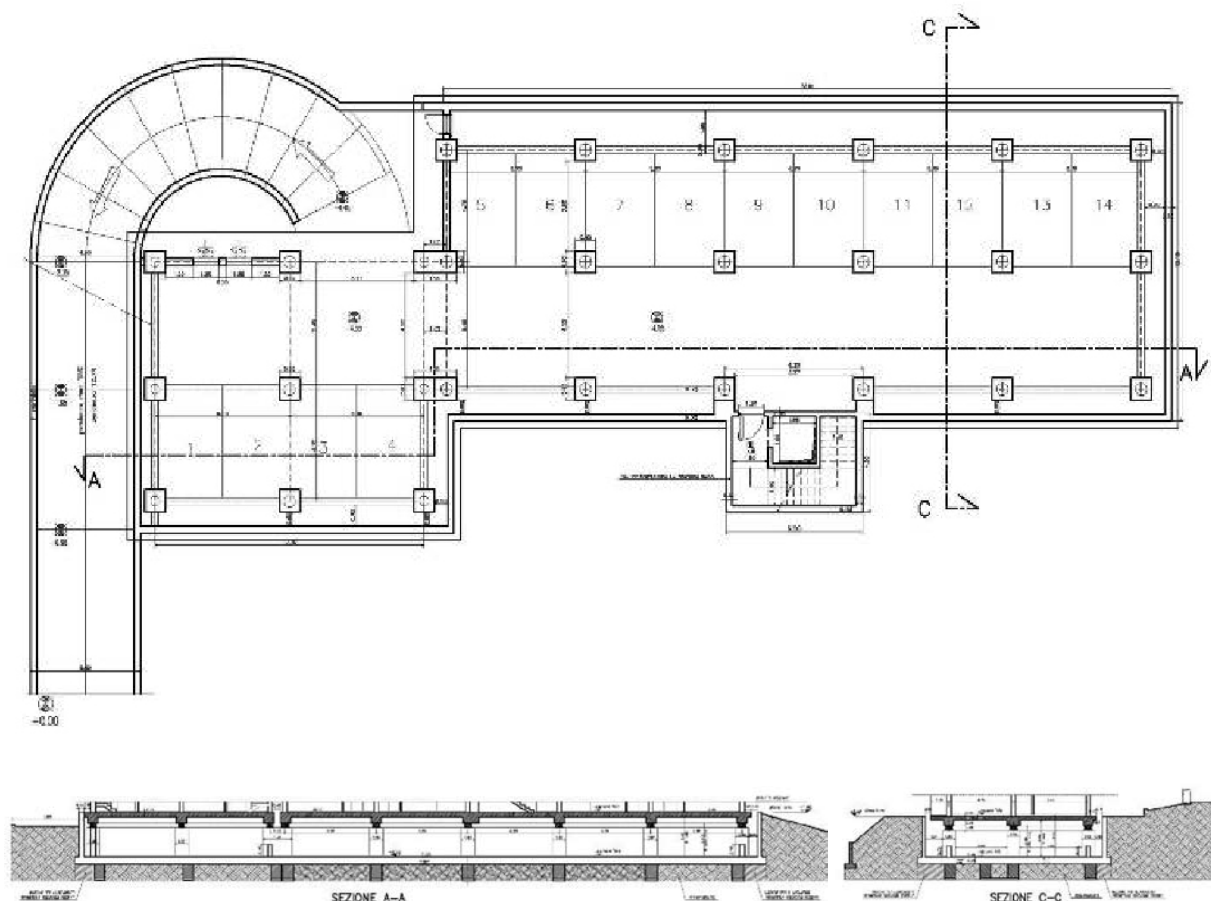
Pianta e sezioni del piano interrato con struttura d'appoggio degli isolatori.
